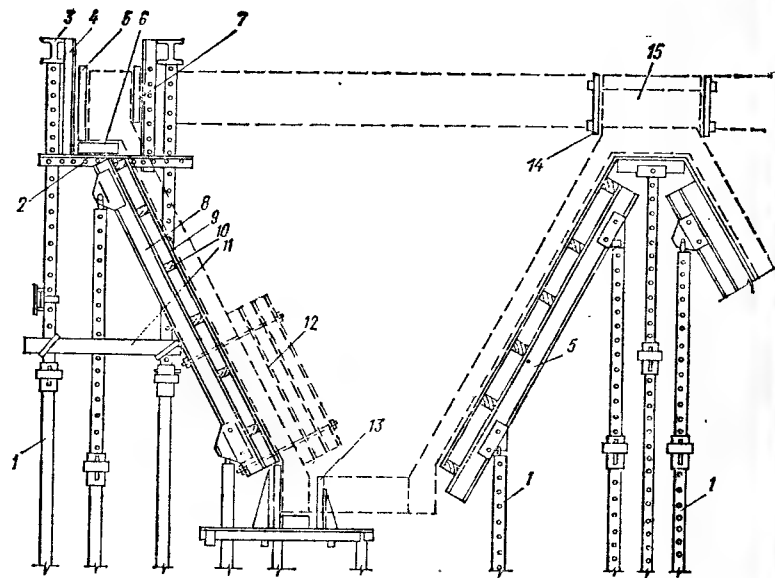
Схема устройства инвентарной опалубки для бетонирования бункеров
